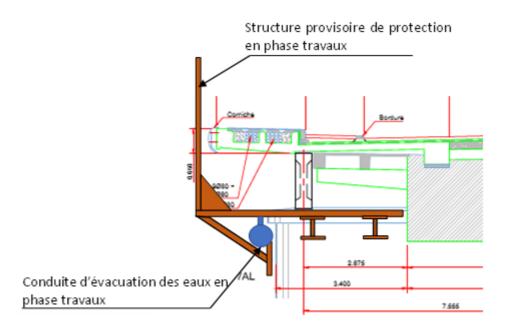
schéma de principe de la structure provisoire de protection sur le Pont Mozart
